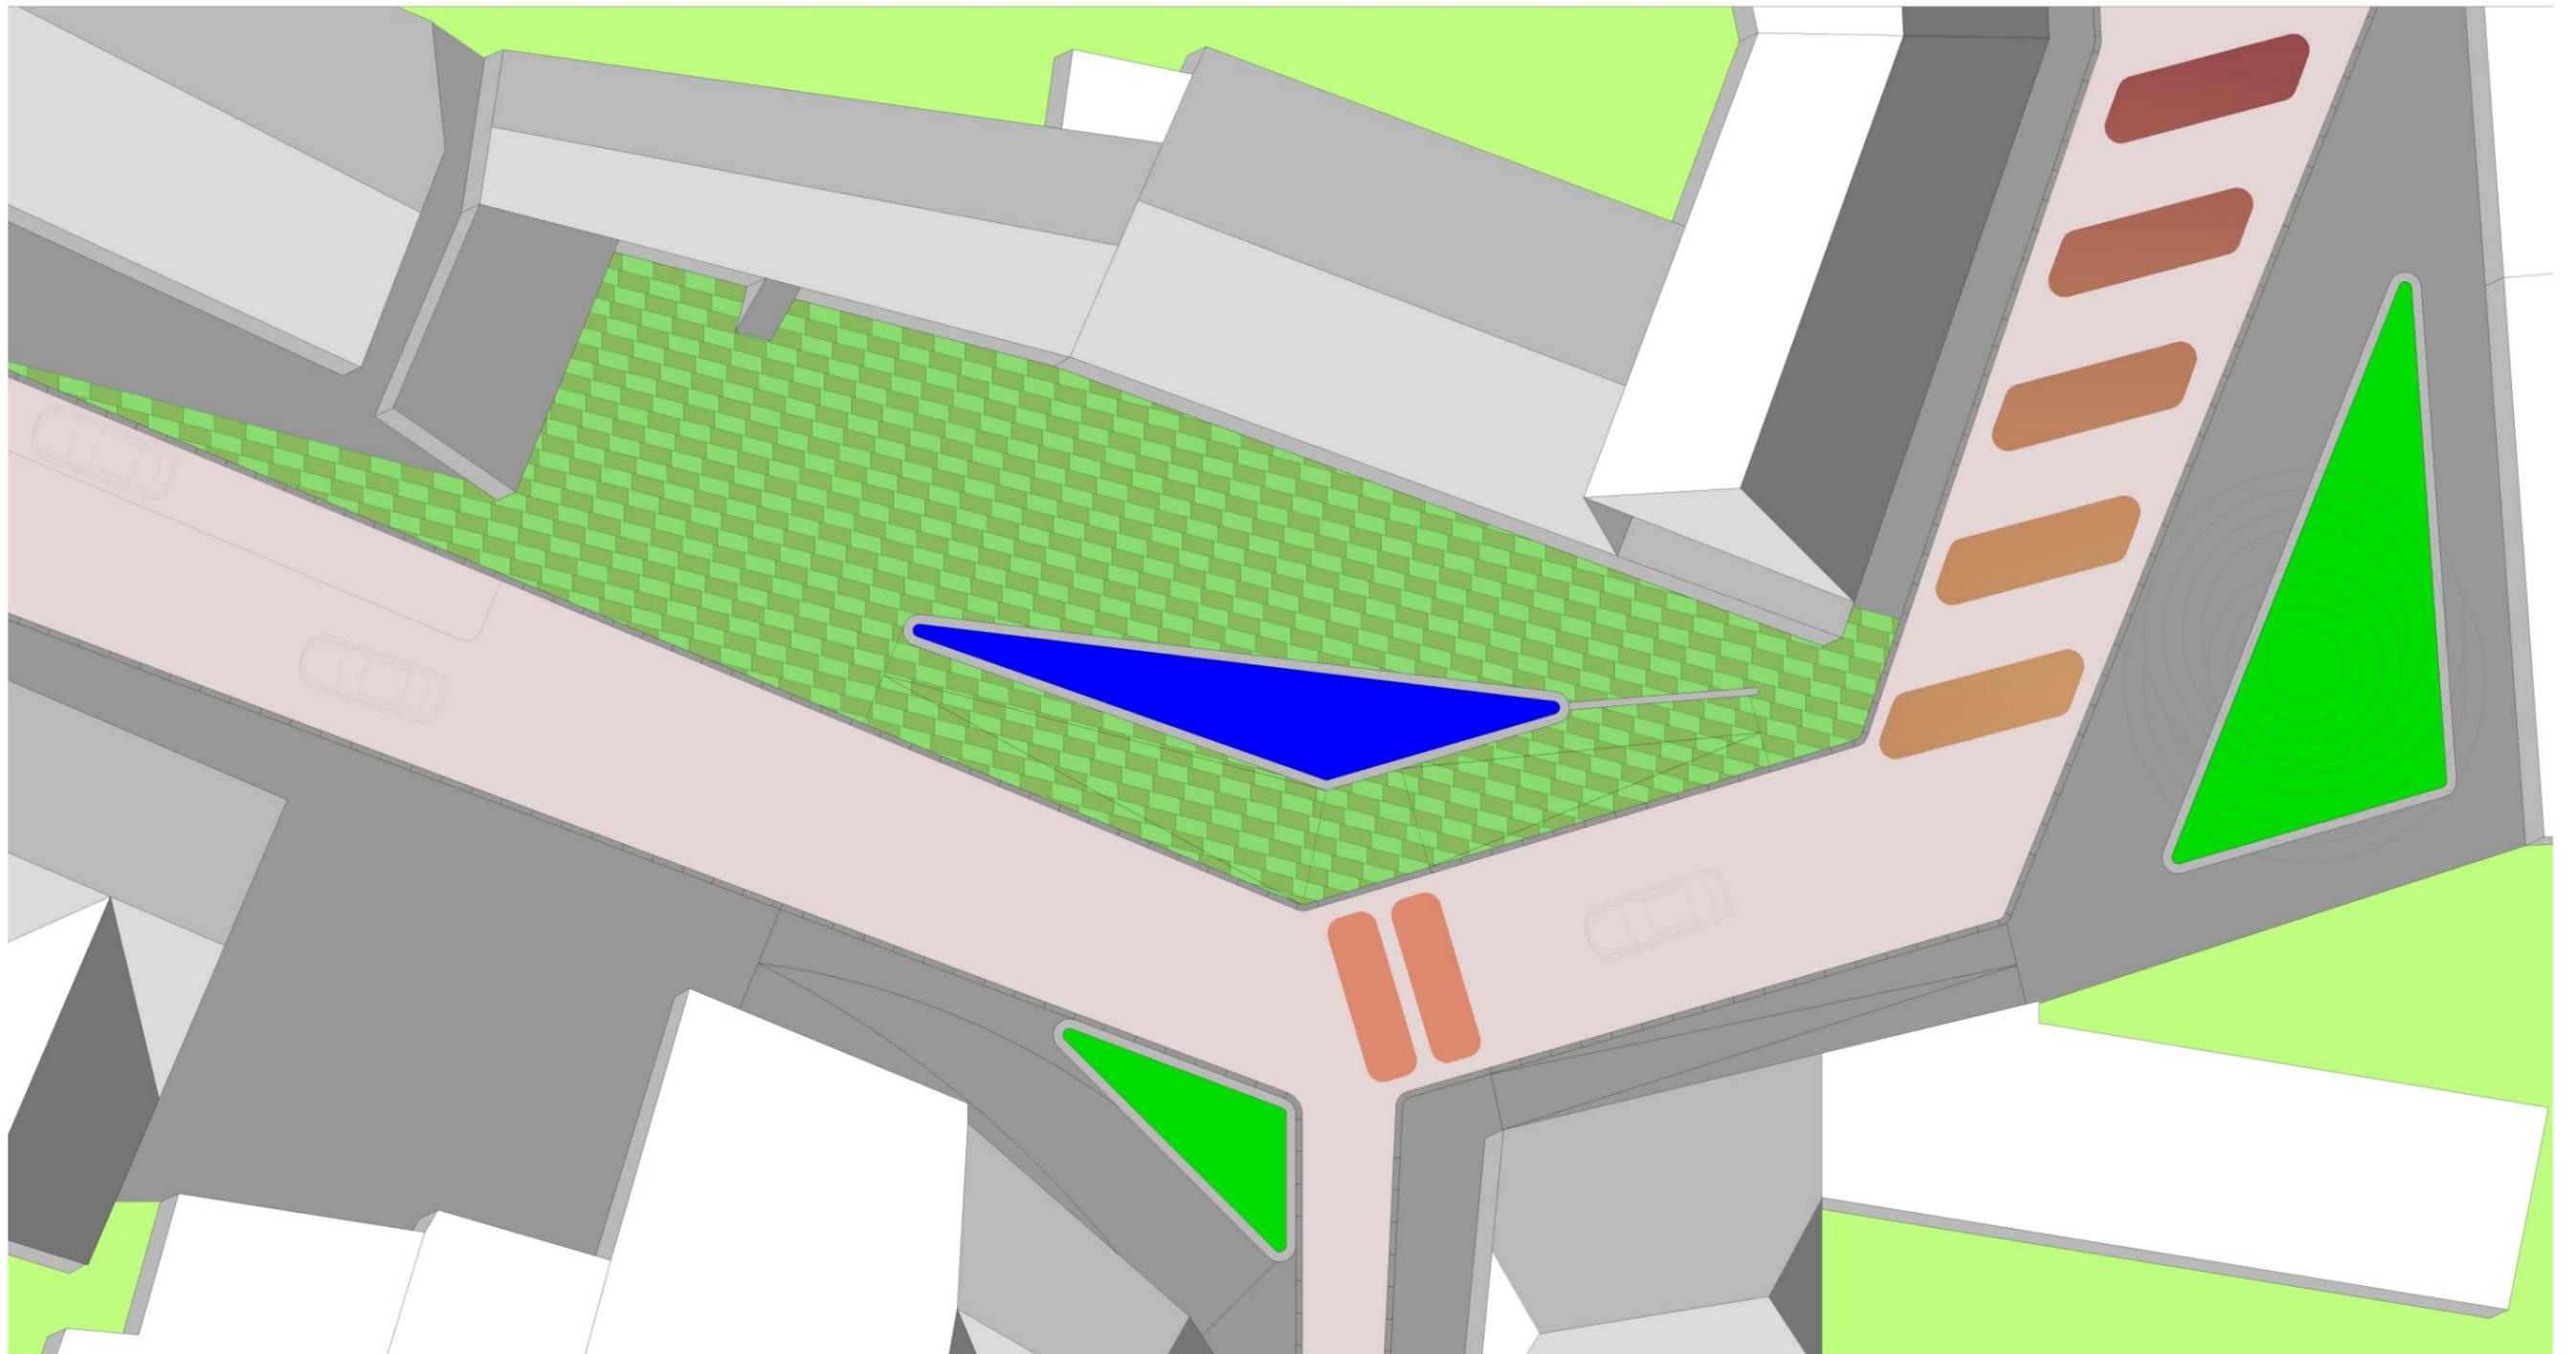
Platzgestaltung Grundriss - Ansicht von Osten
